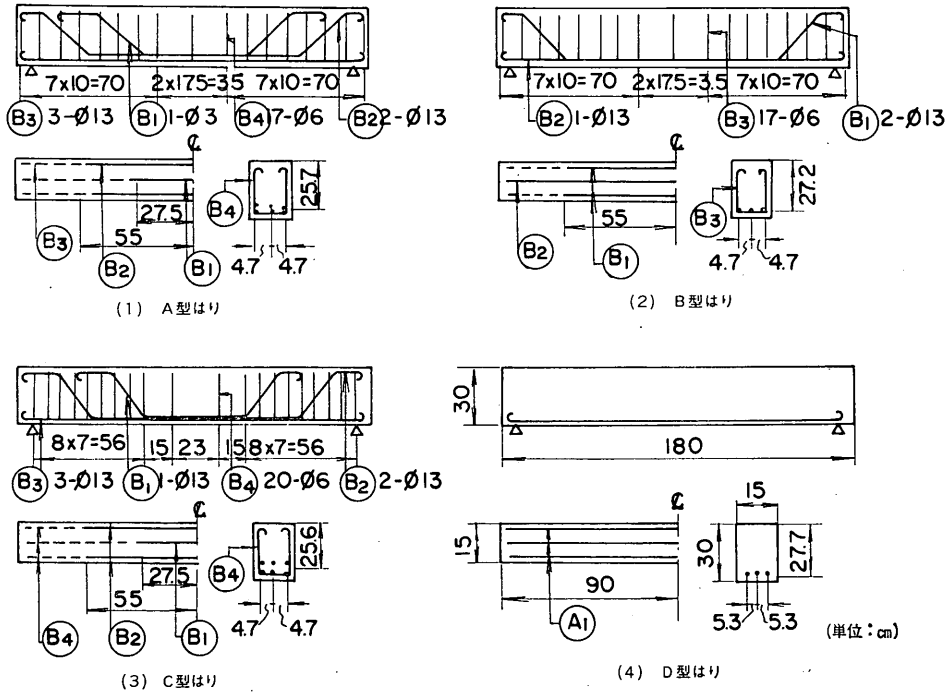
鉄筋コンクリートはりの形状, 寸法および配筋図
